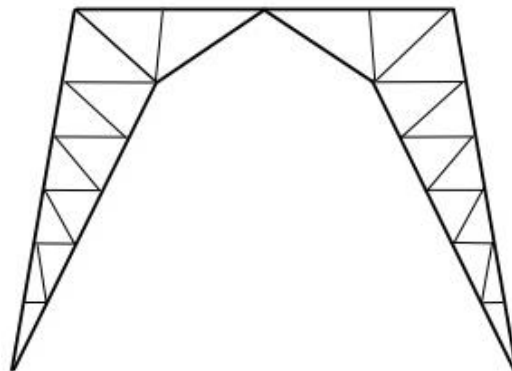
Modelo de contraventamento tipo “K” quebrado (Fonte: EC3-3-1)
